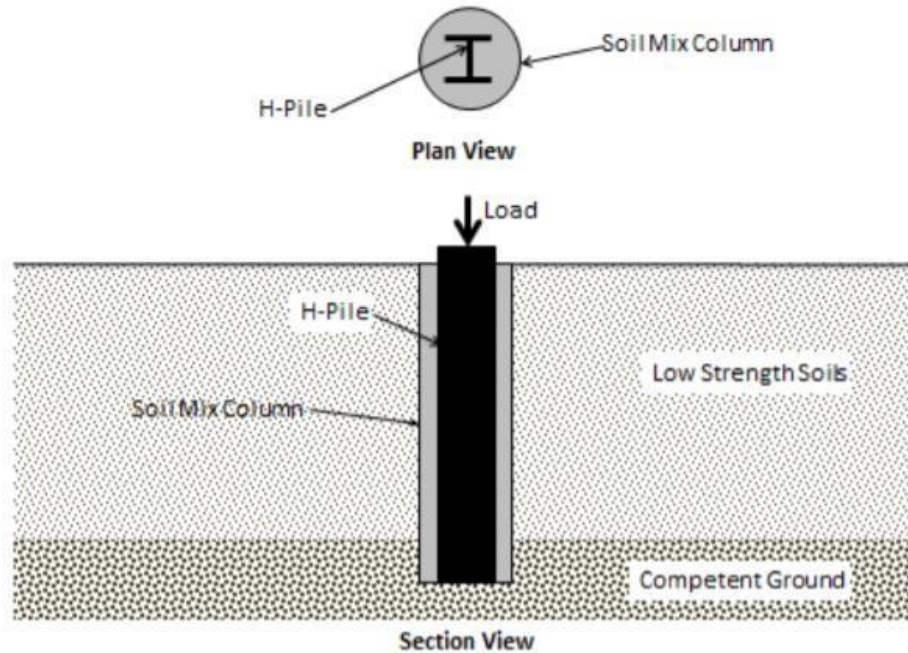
Ejemplo para sistemas de fundaciones profundas [7].
